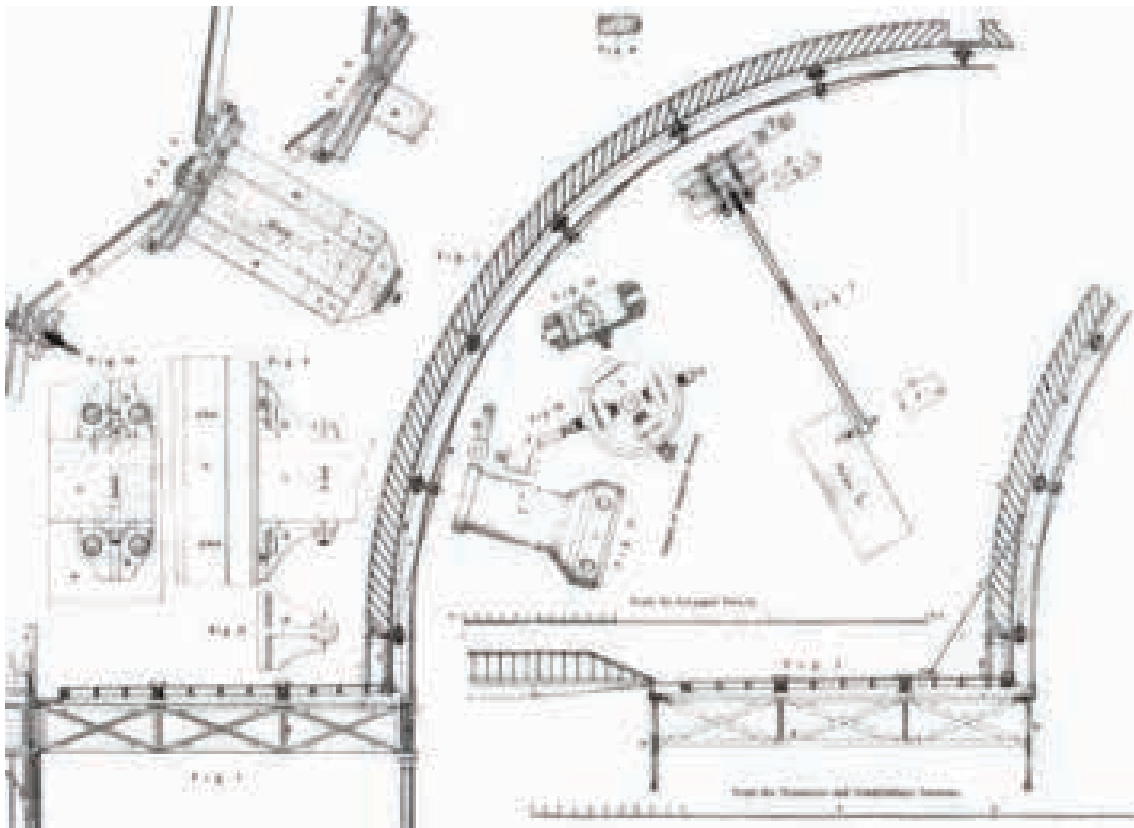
“Crystal Palace, construction details, Joseph Paxton with Fox and Henderson” (Frampton, 1995, p. 44)
